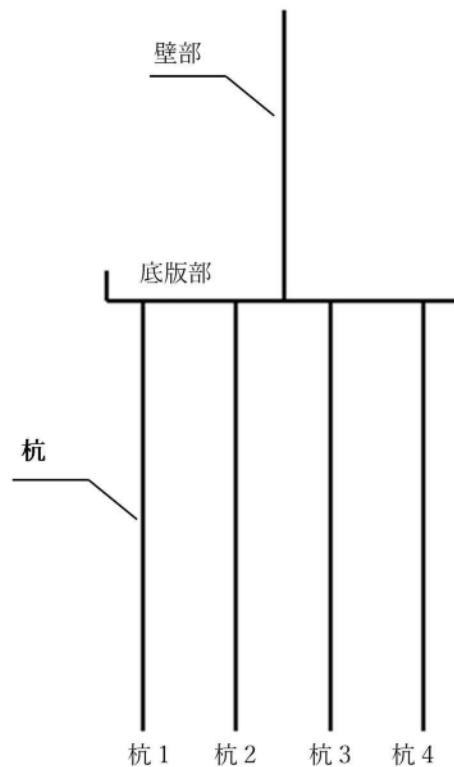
防潮扉 2 基礎 杭番号位置図
